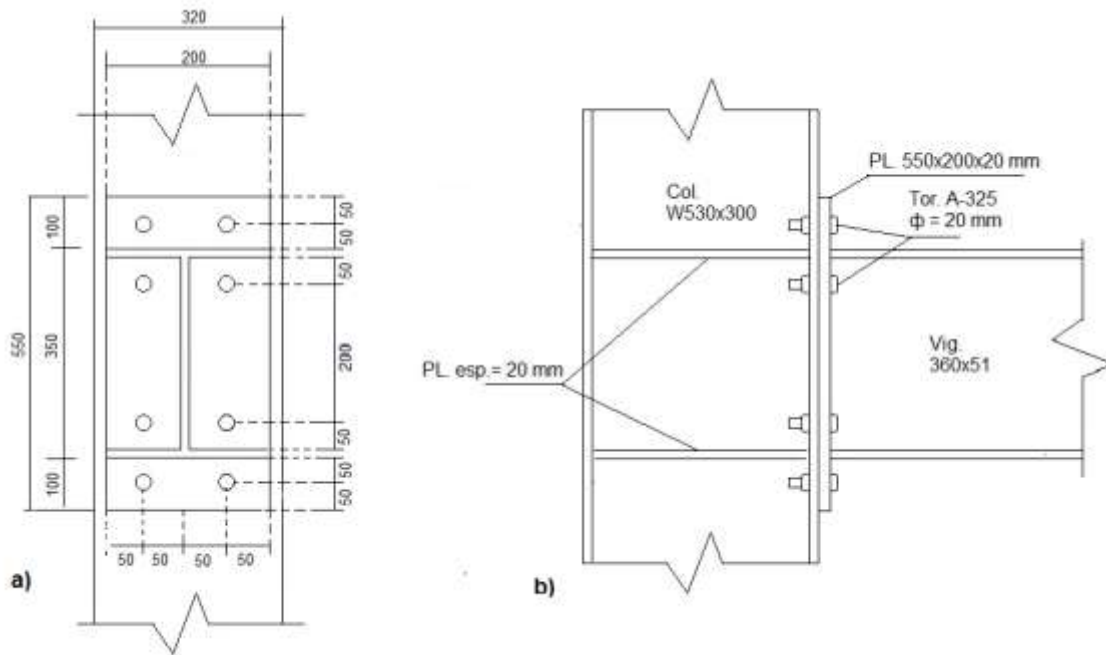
a) Distribución de tornillería, y b) vista en elevación de la conexión. (medidas en mm)
